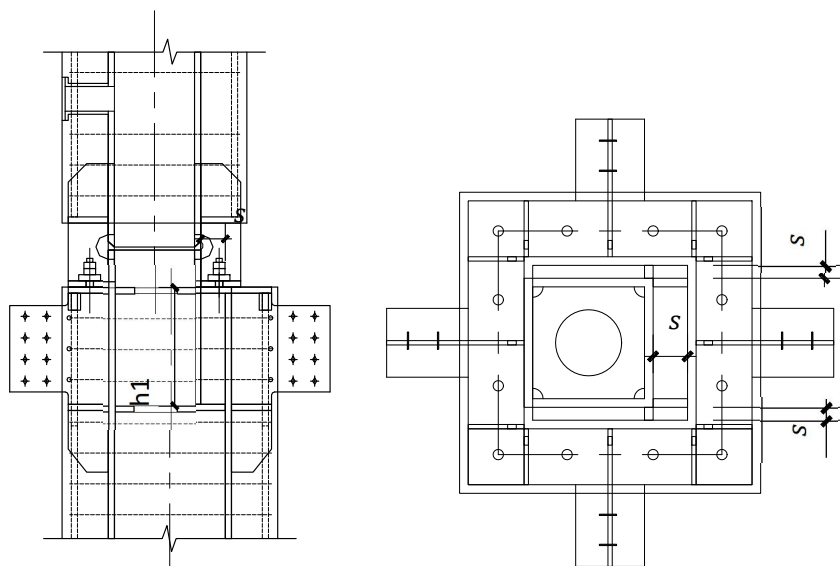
b 矩形截面预制型钢混凝土柱变截面拼接节点的构造
